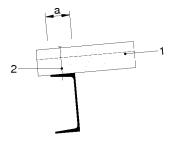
Stahl-Auflager Bild 2 Holz-Auflager Bild 3 Beton-Auflager
